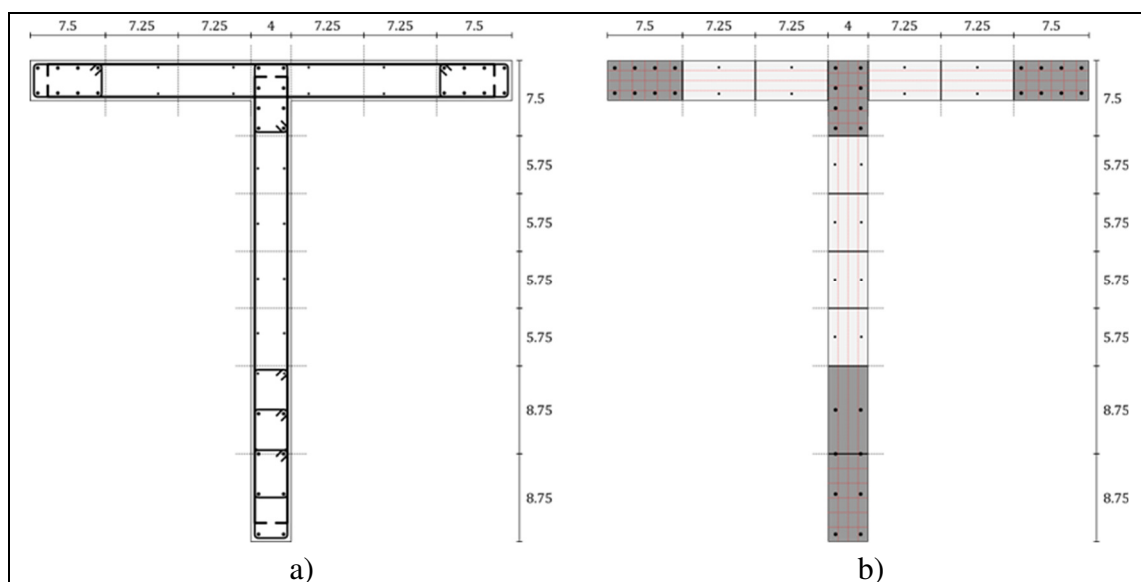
Sección transversal del muro TW2. a) Secciones. b) Discretización en fibras. Dimensiones en pulgadas.
